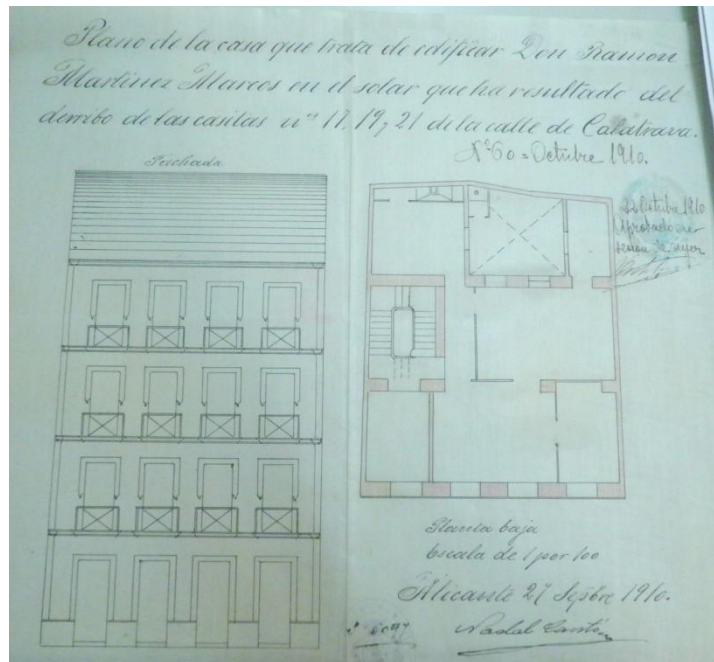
Alzado y planta originales. Médico Manero Mollà, nº 13.
